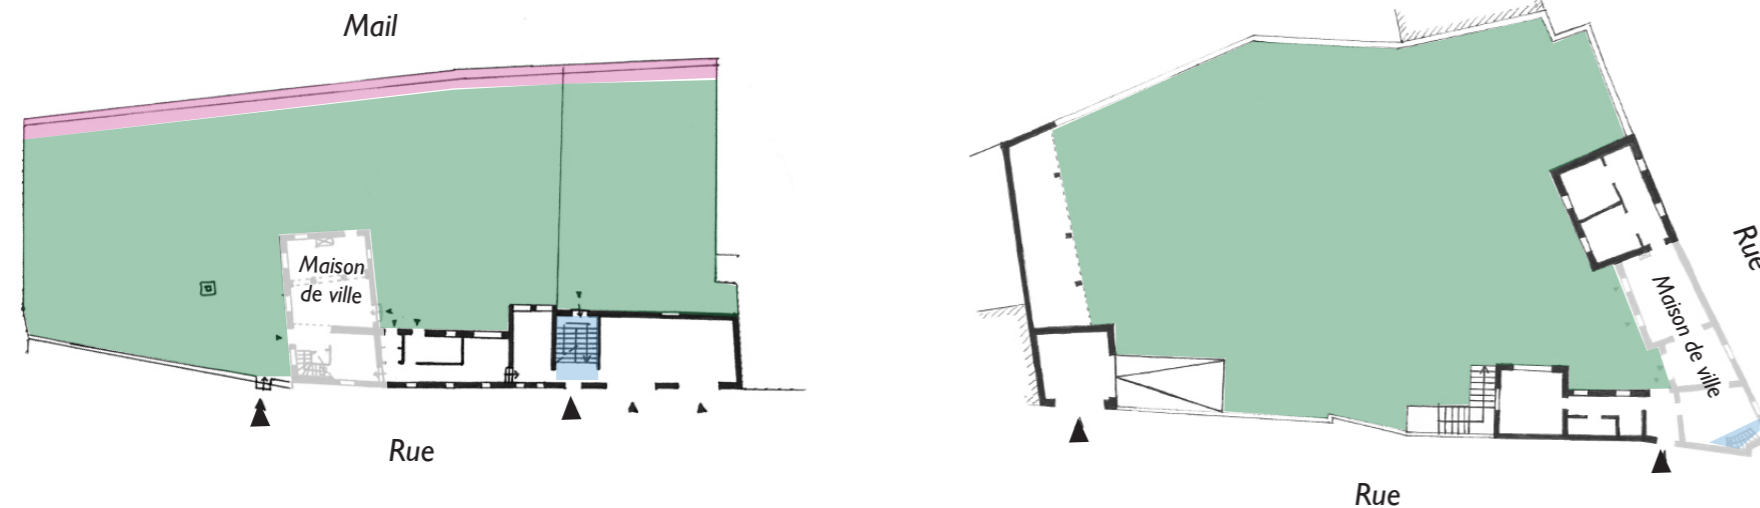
Plans rez-de-chaussée des extensions de maisons de ville
